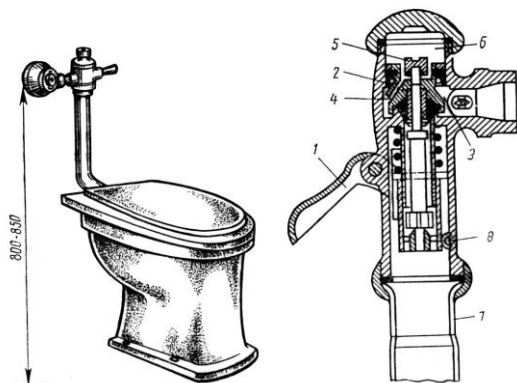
Схема монтажа и конструкция полуавтоматического поршневого смывного крана [14]: 1 – рычаг пуска; 2 – поршень; 3 – входная камера; 4 – канал; 5 – вспомогательный клапан; 6 – рабочая камера; 7 – отводящая труба; 8 – корпус
